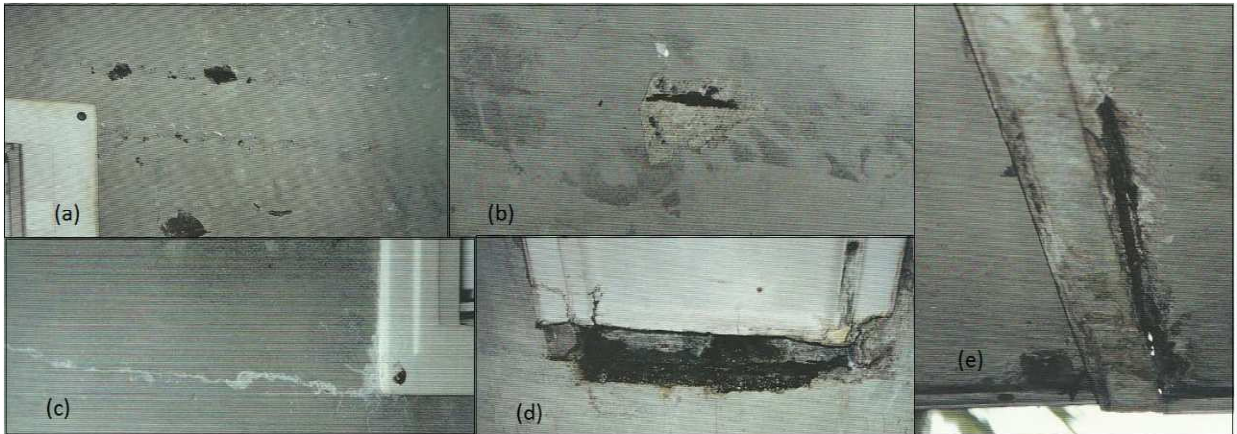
Laje do prédio principal em 2000 – (a) cobertura quase nula, (b) armadura exposta, (c) fissura, (d) comprometimento próximo à luminária e (e) junta de dilatação deteriorada com armadura exposta.
